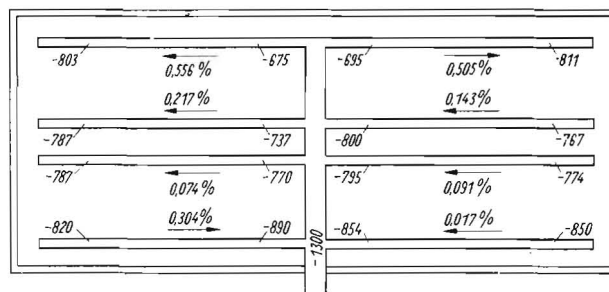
Grundriß des Stalles mit Tiefenangabe und Neigung der Kanalsohle
